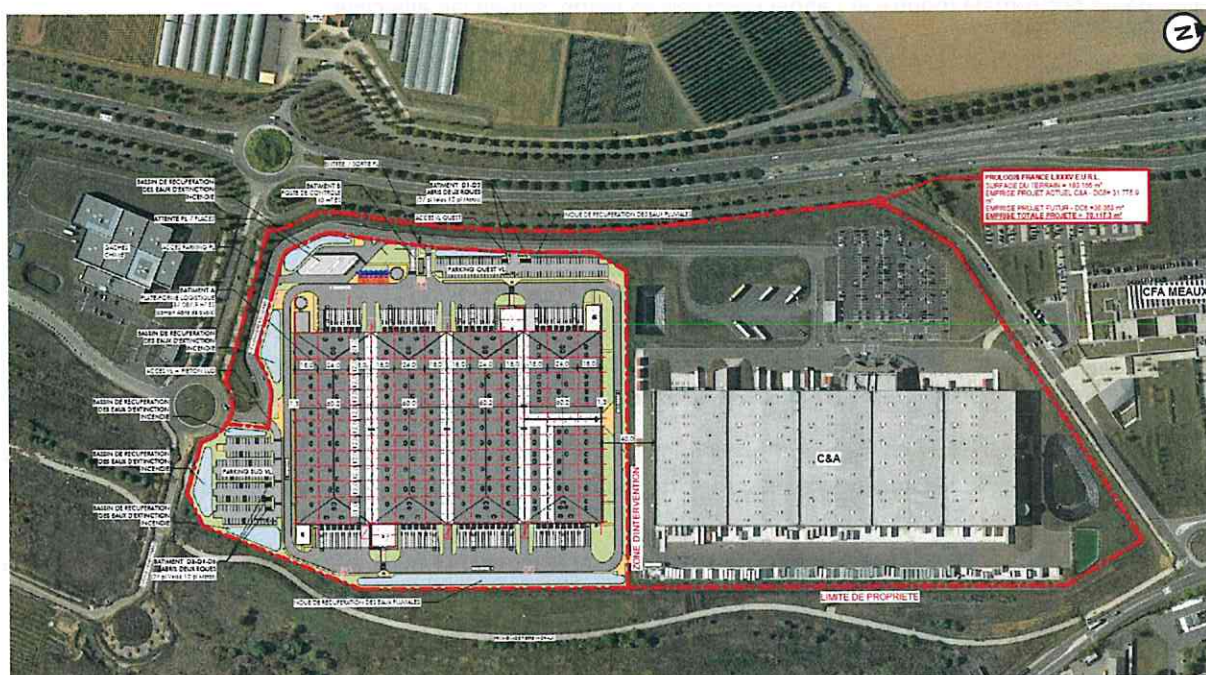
Plan de masse du site projeté sur une vue aérienne
